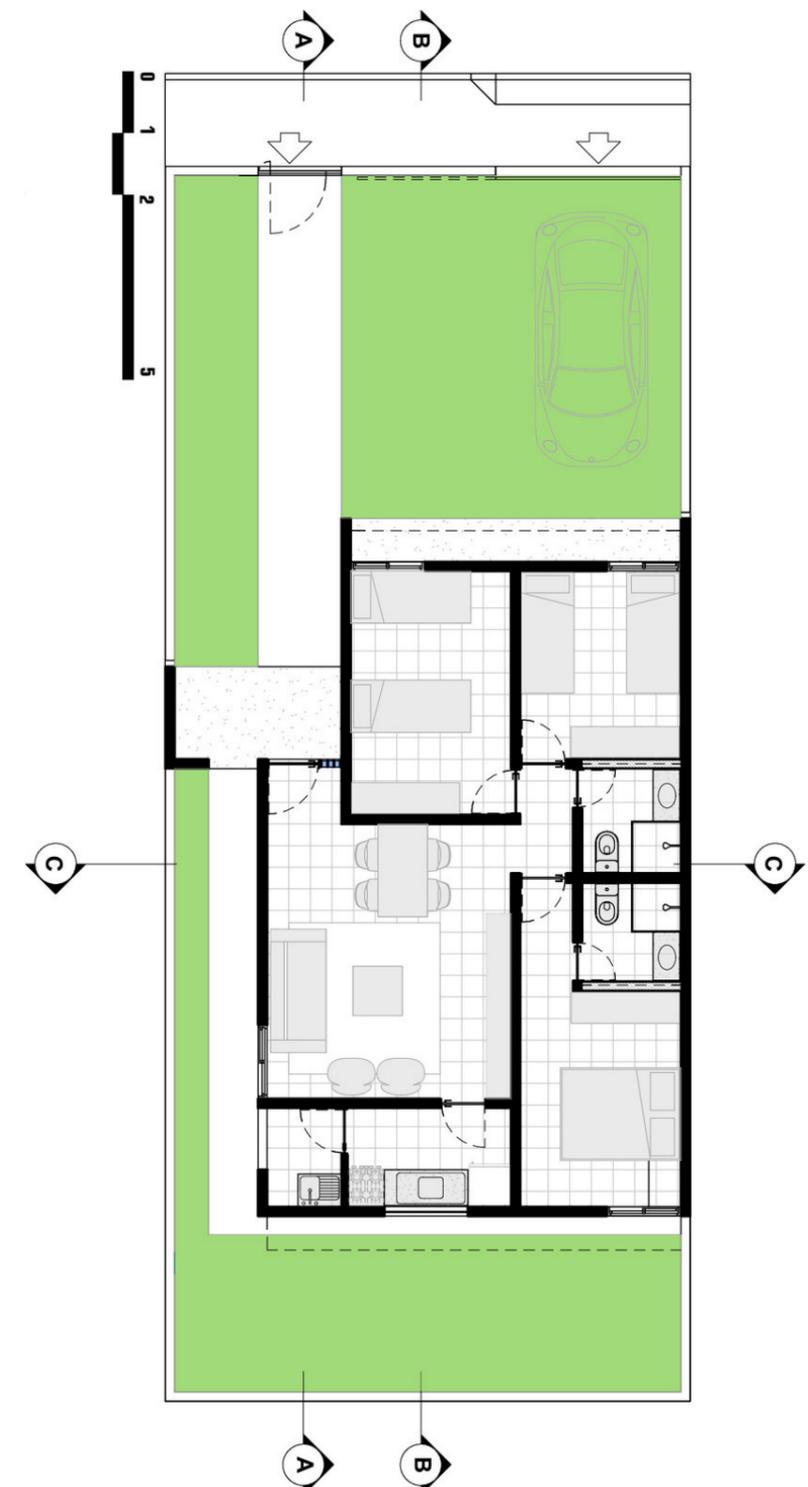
PLANTA OPÇÃO COM 3 QUARTOS, SENDO
